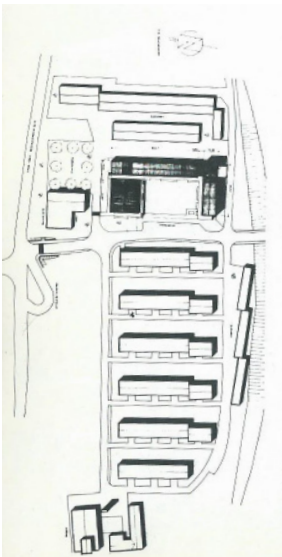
Bebauungsplan Schirmitzbühel-Zentrum
